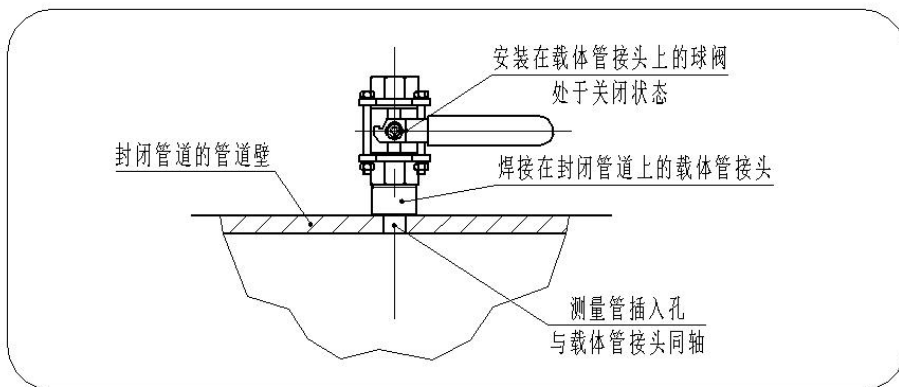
焊接在管道上的焊接底座及安装在焊接底座上的球阀
